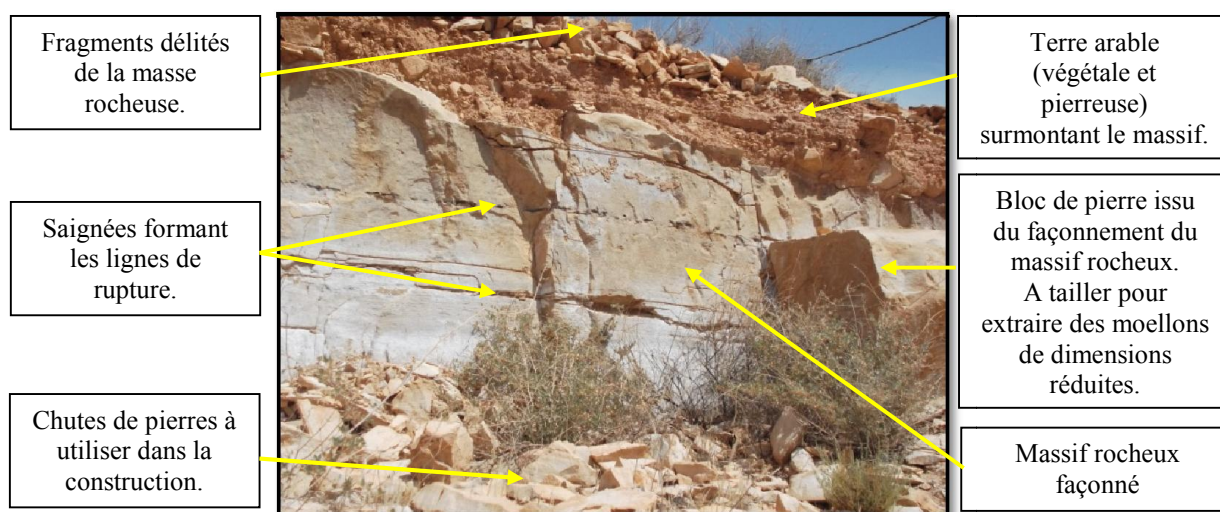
Massif rocheux façonné par l'extraction de la pierre, site de Tabaalit.
